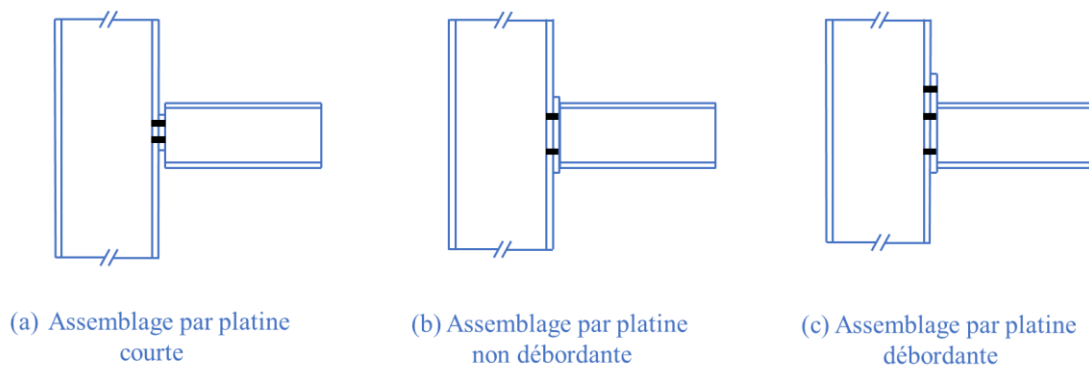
Configurations d'un assemblage poteau-poutre par platine d'extrémité.
